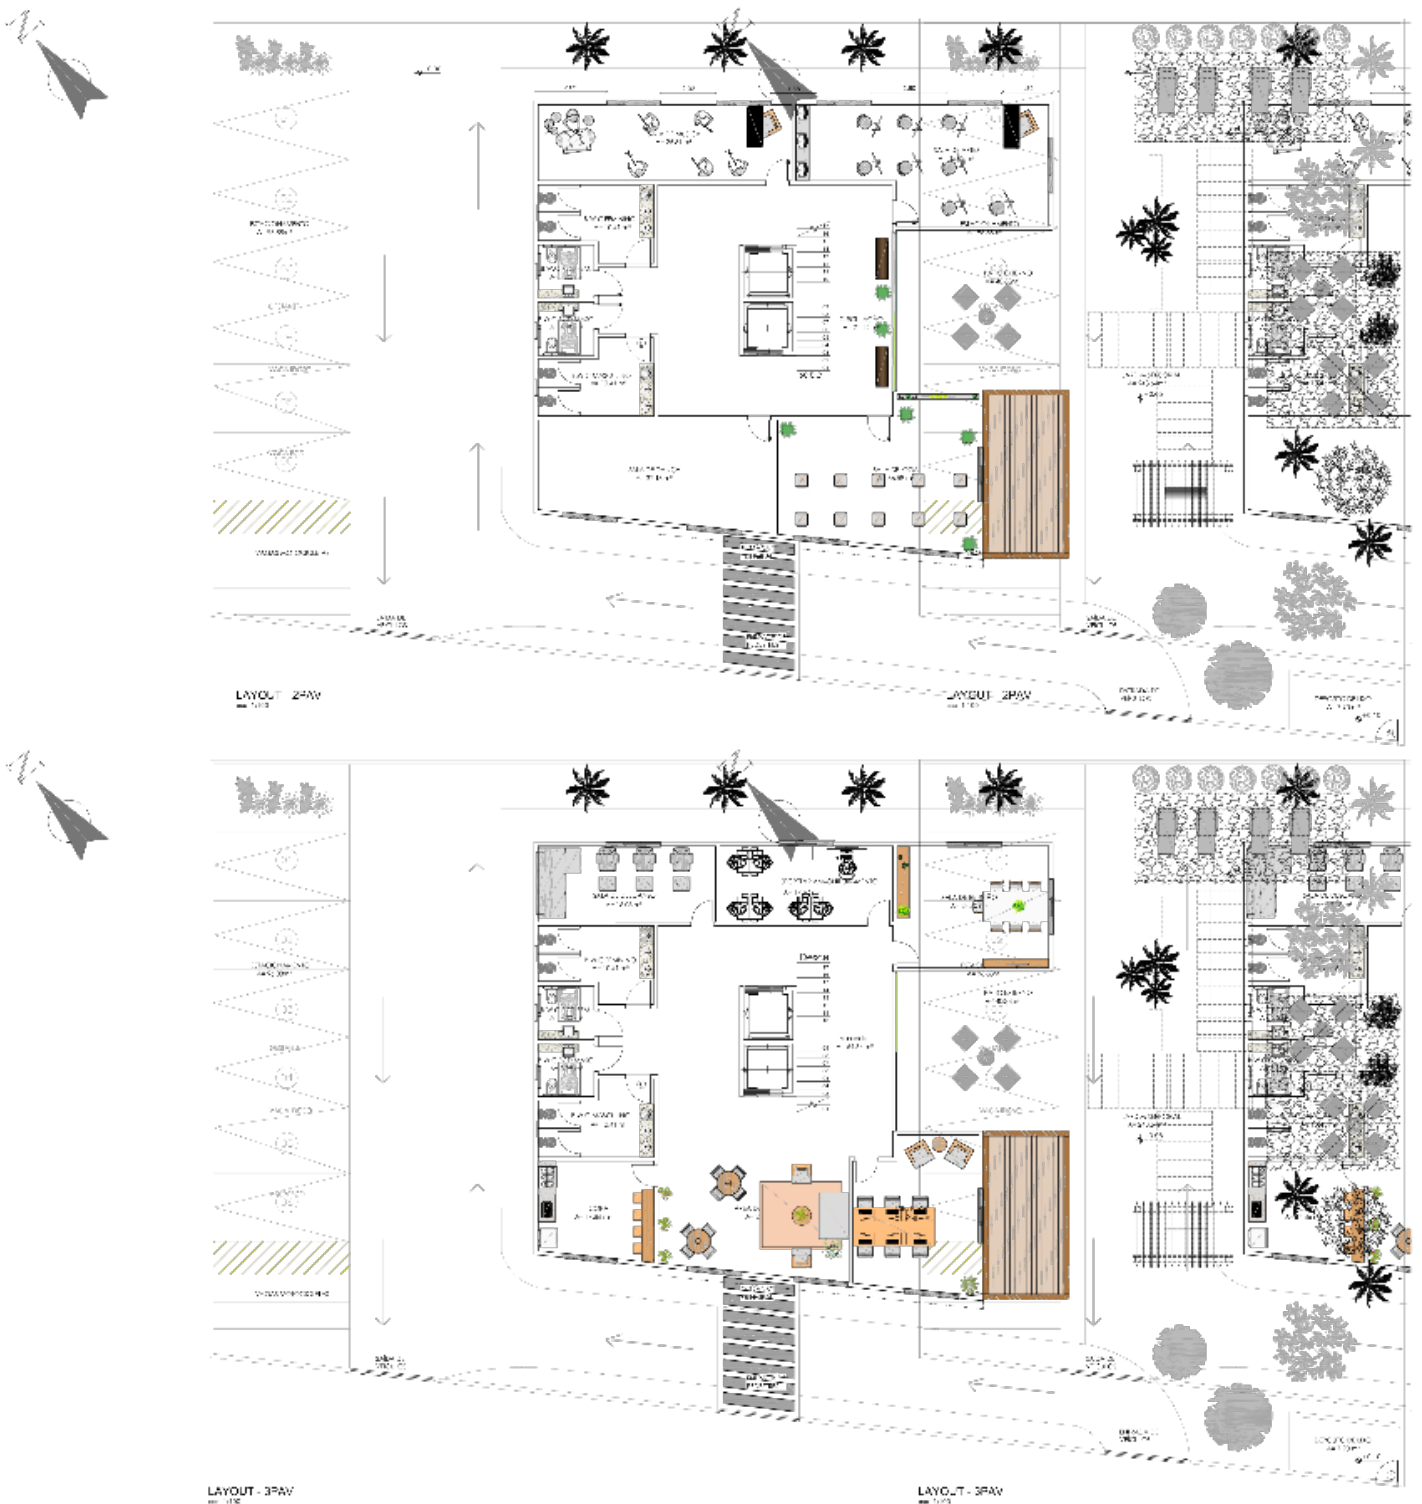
Planta de layout do segundo e terceiro pavimento
